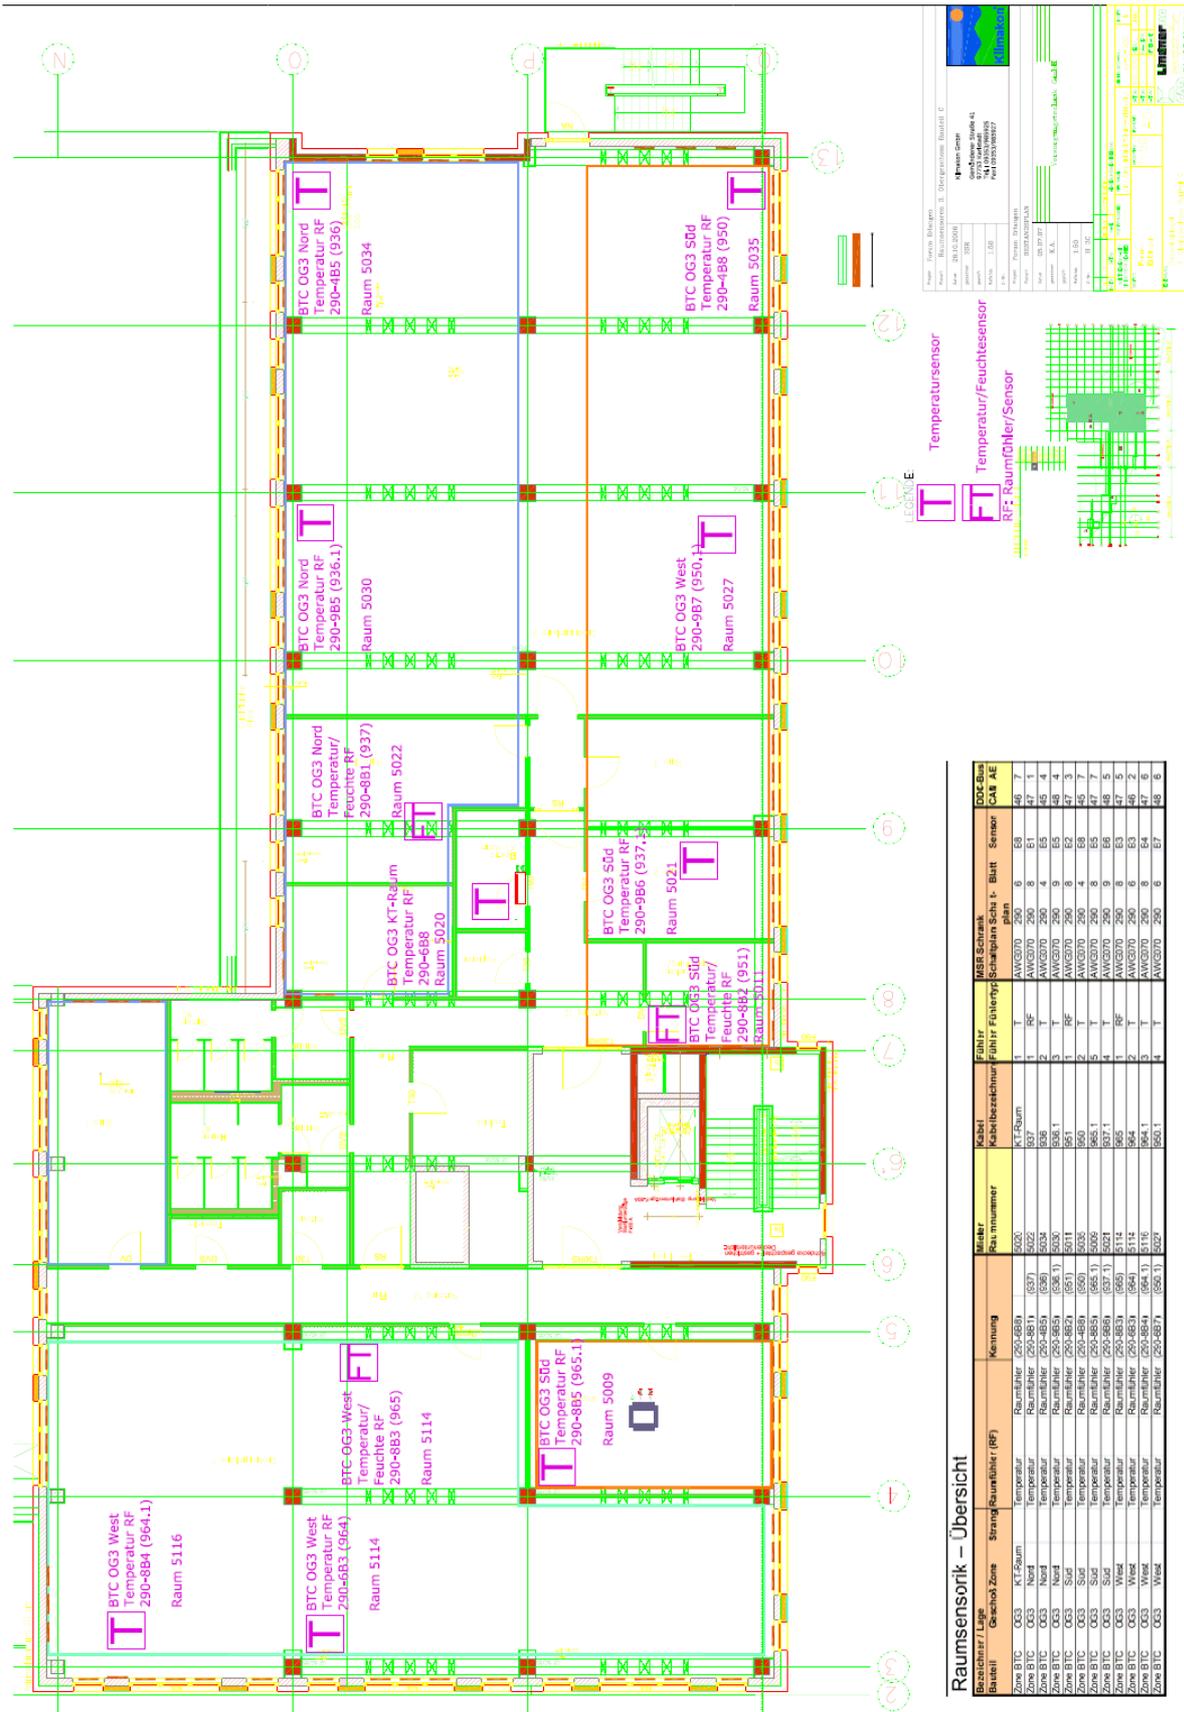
Grundriss mit Zoneneinteilung und Fühlerpositionen
